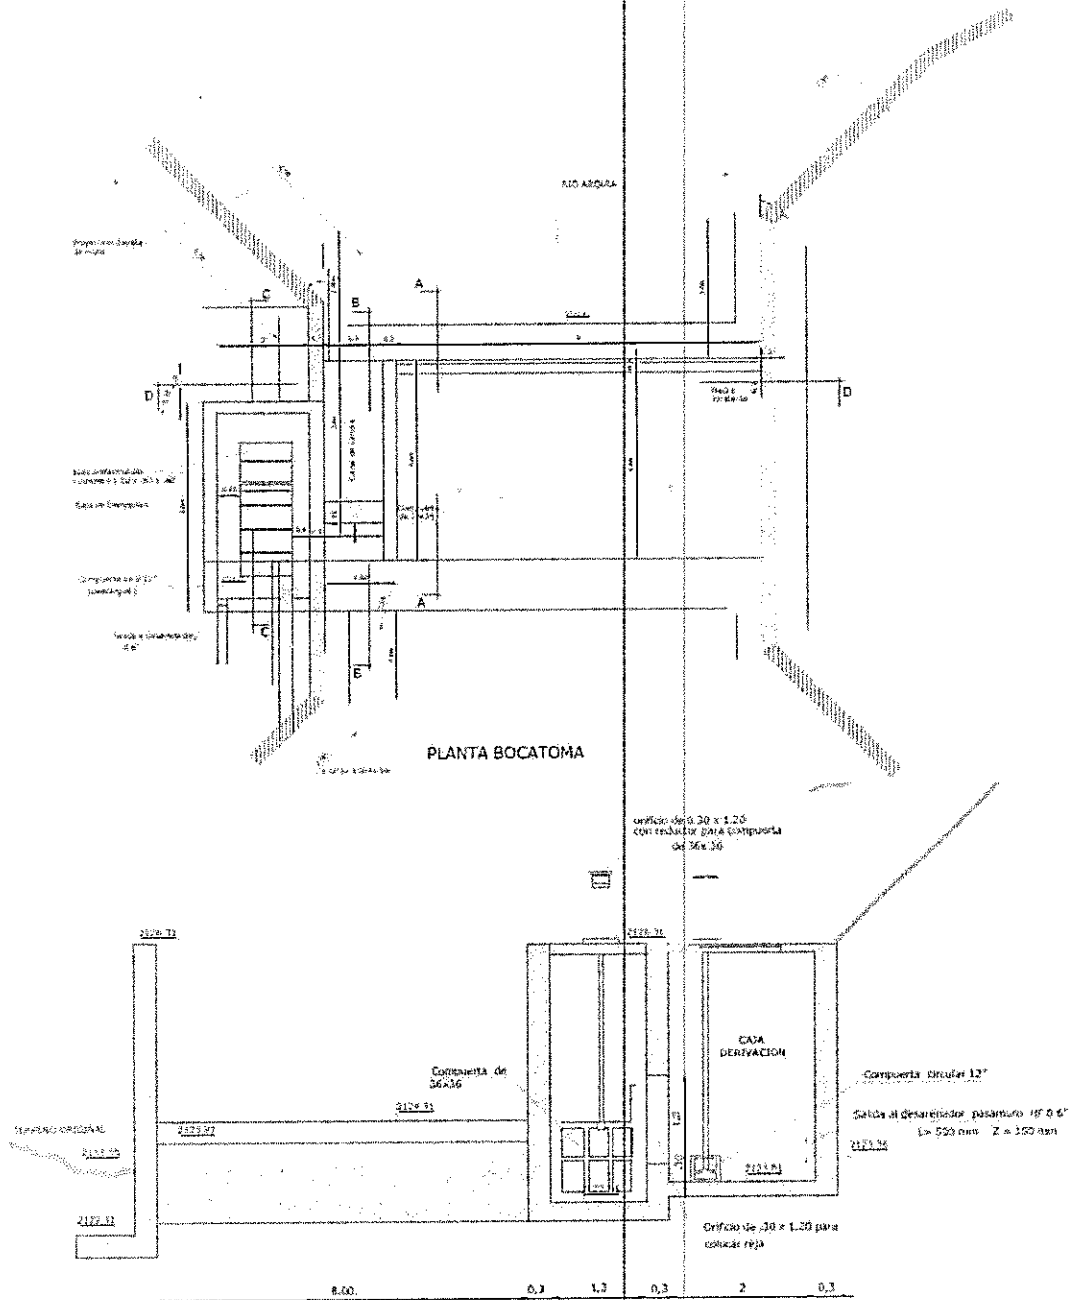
Plano detalle bocatoma del sistema aducción PTAP Marmato
